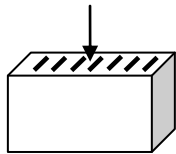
Схемы приложения нагрузки к камню при испытаниях на сжатие
